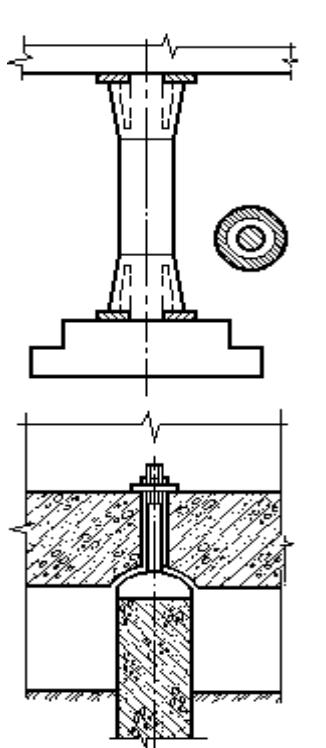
Конструкция свайного фундамента с высоким ростверком.
